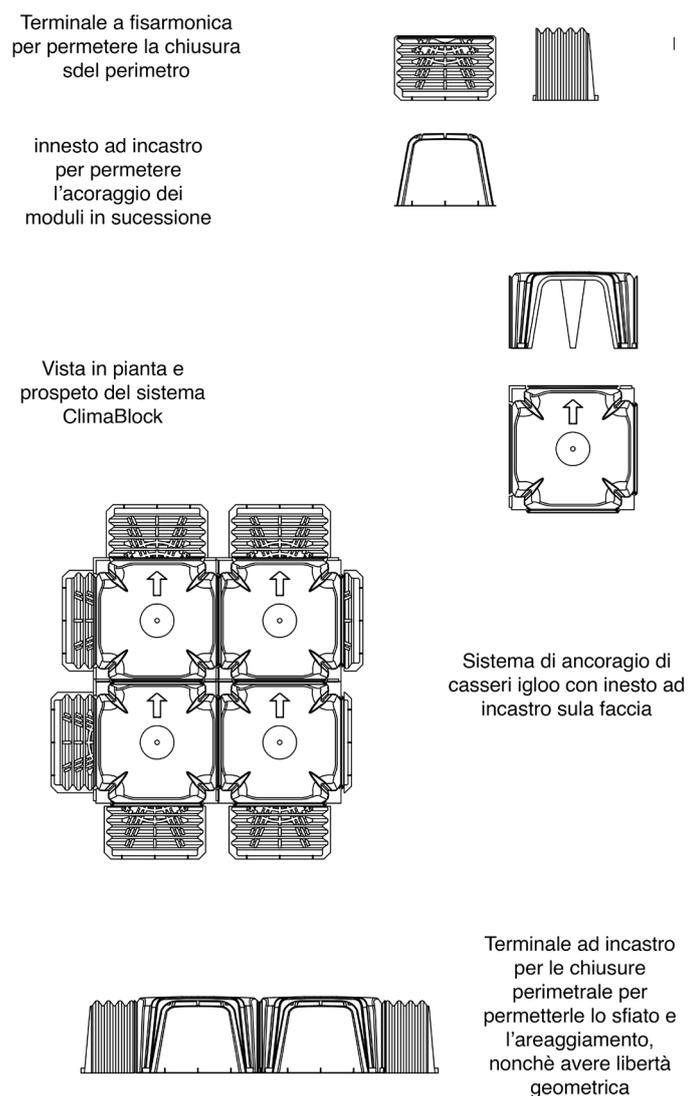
Schema di ancoraggio in pianta e prospetti del sistema a solaio aerato.
